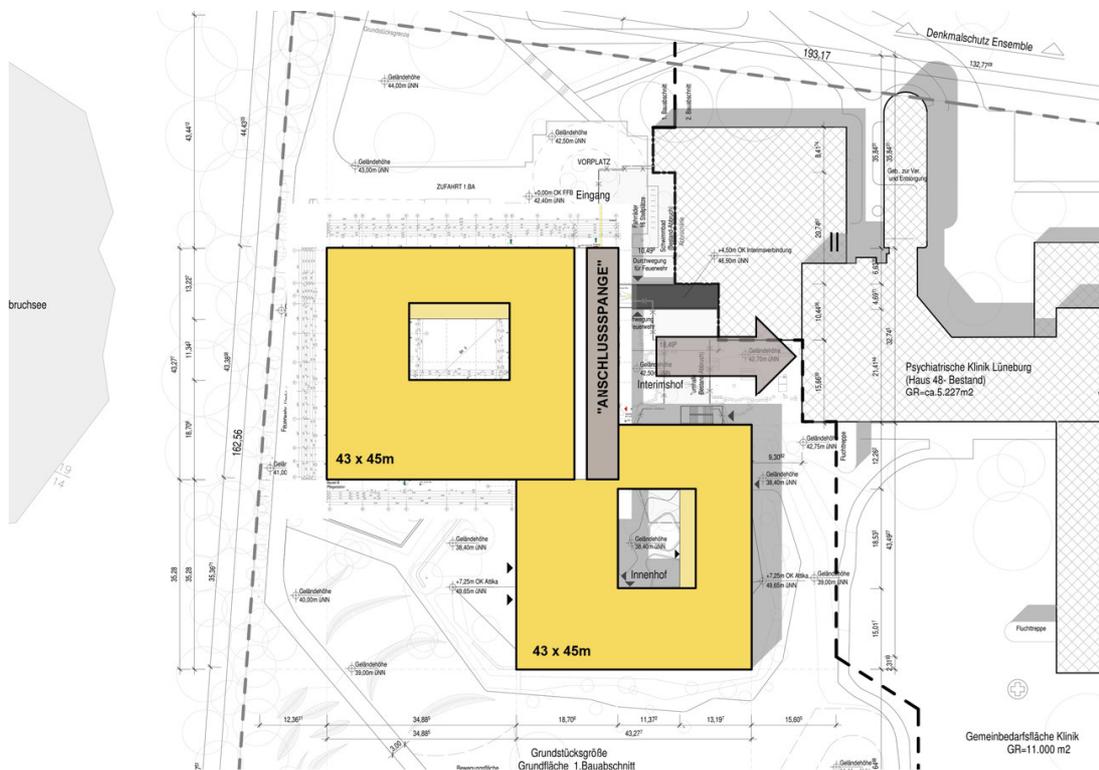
\_ geplanter Stationsbaukörper mit Anschlussbereich
